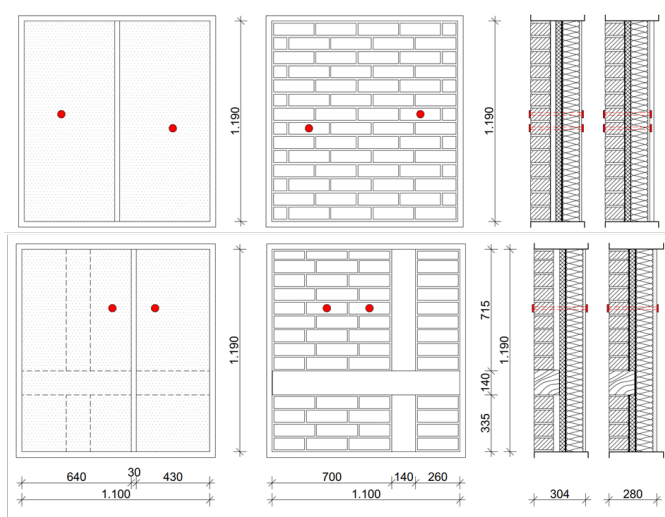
Wandaufbau der neuen Testfassade – oben: Westseite; unten: Ostseite; links: Innenansicht; Mitte: Außenansicht; rechts: Schnitt 1 mit Luftschicht, Schnitt 2 ohne Luftschicht; Quelle: UdK Berlin, Fachgebiet VPT
